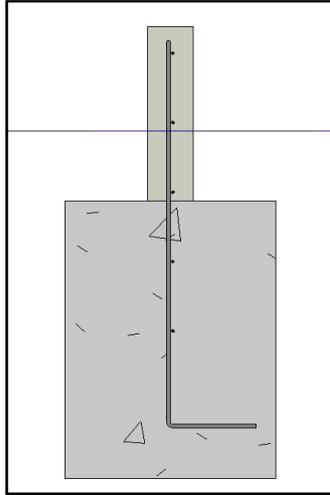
Modelado de Acero de Refuerzo en Zapatas
